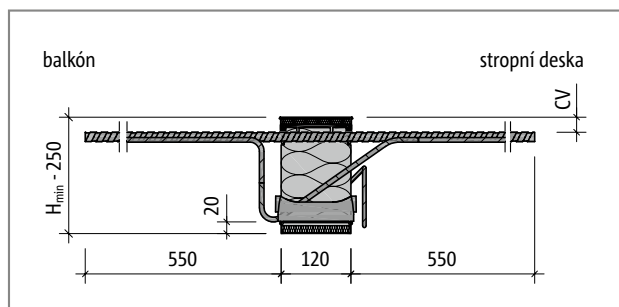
Schöck Isokorb® CXT typ KL-M3-V2: Půdorys prvku
